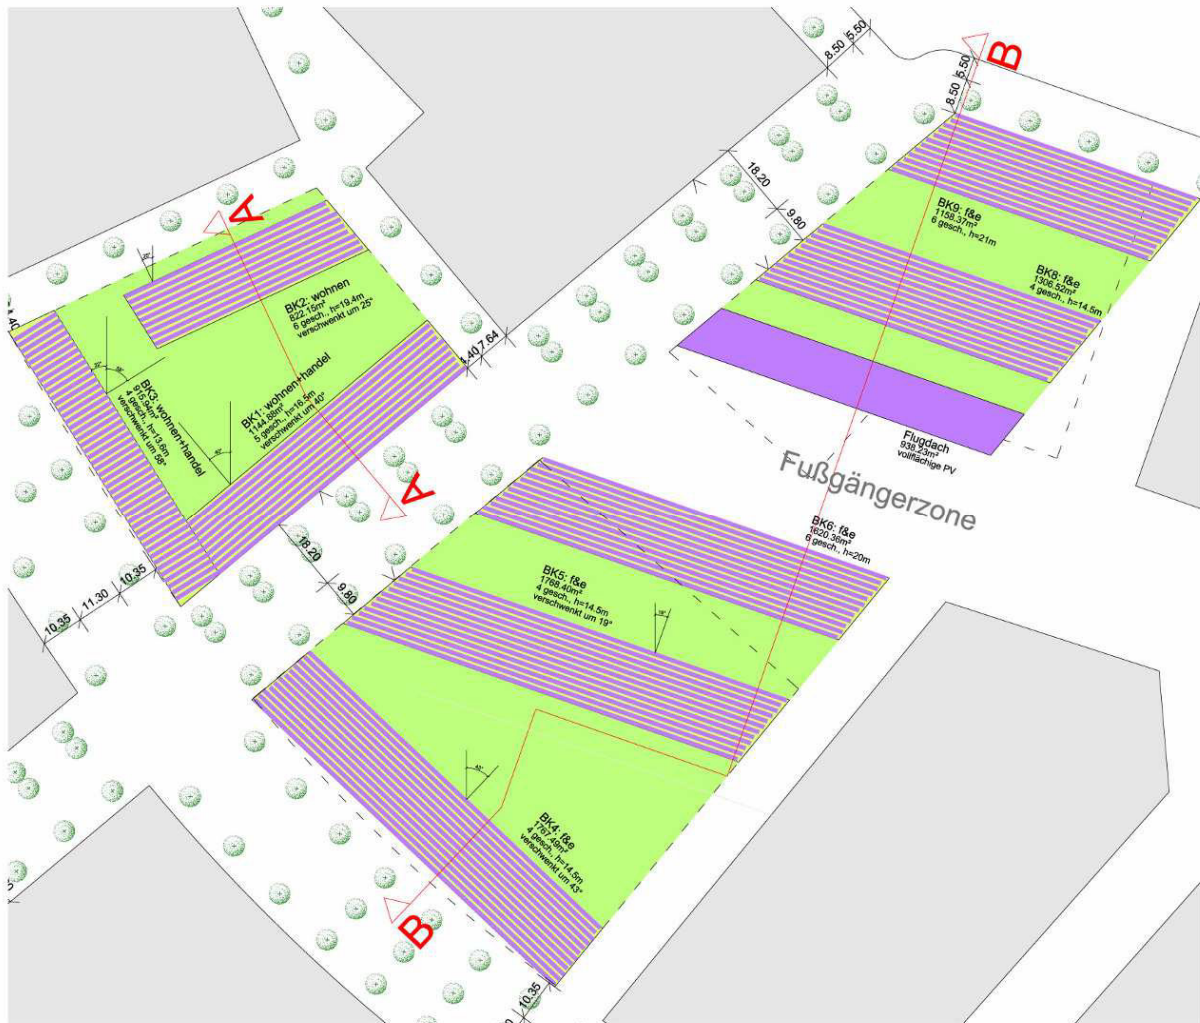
PV-optimierter-Entwurf – Lageplan, Dachdraufsicht
